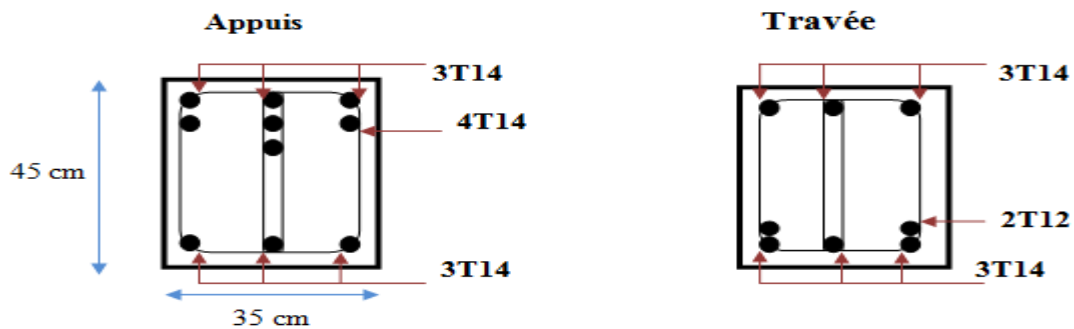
Schémas de ferrailage des poutres principales (35×45)
